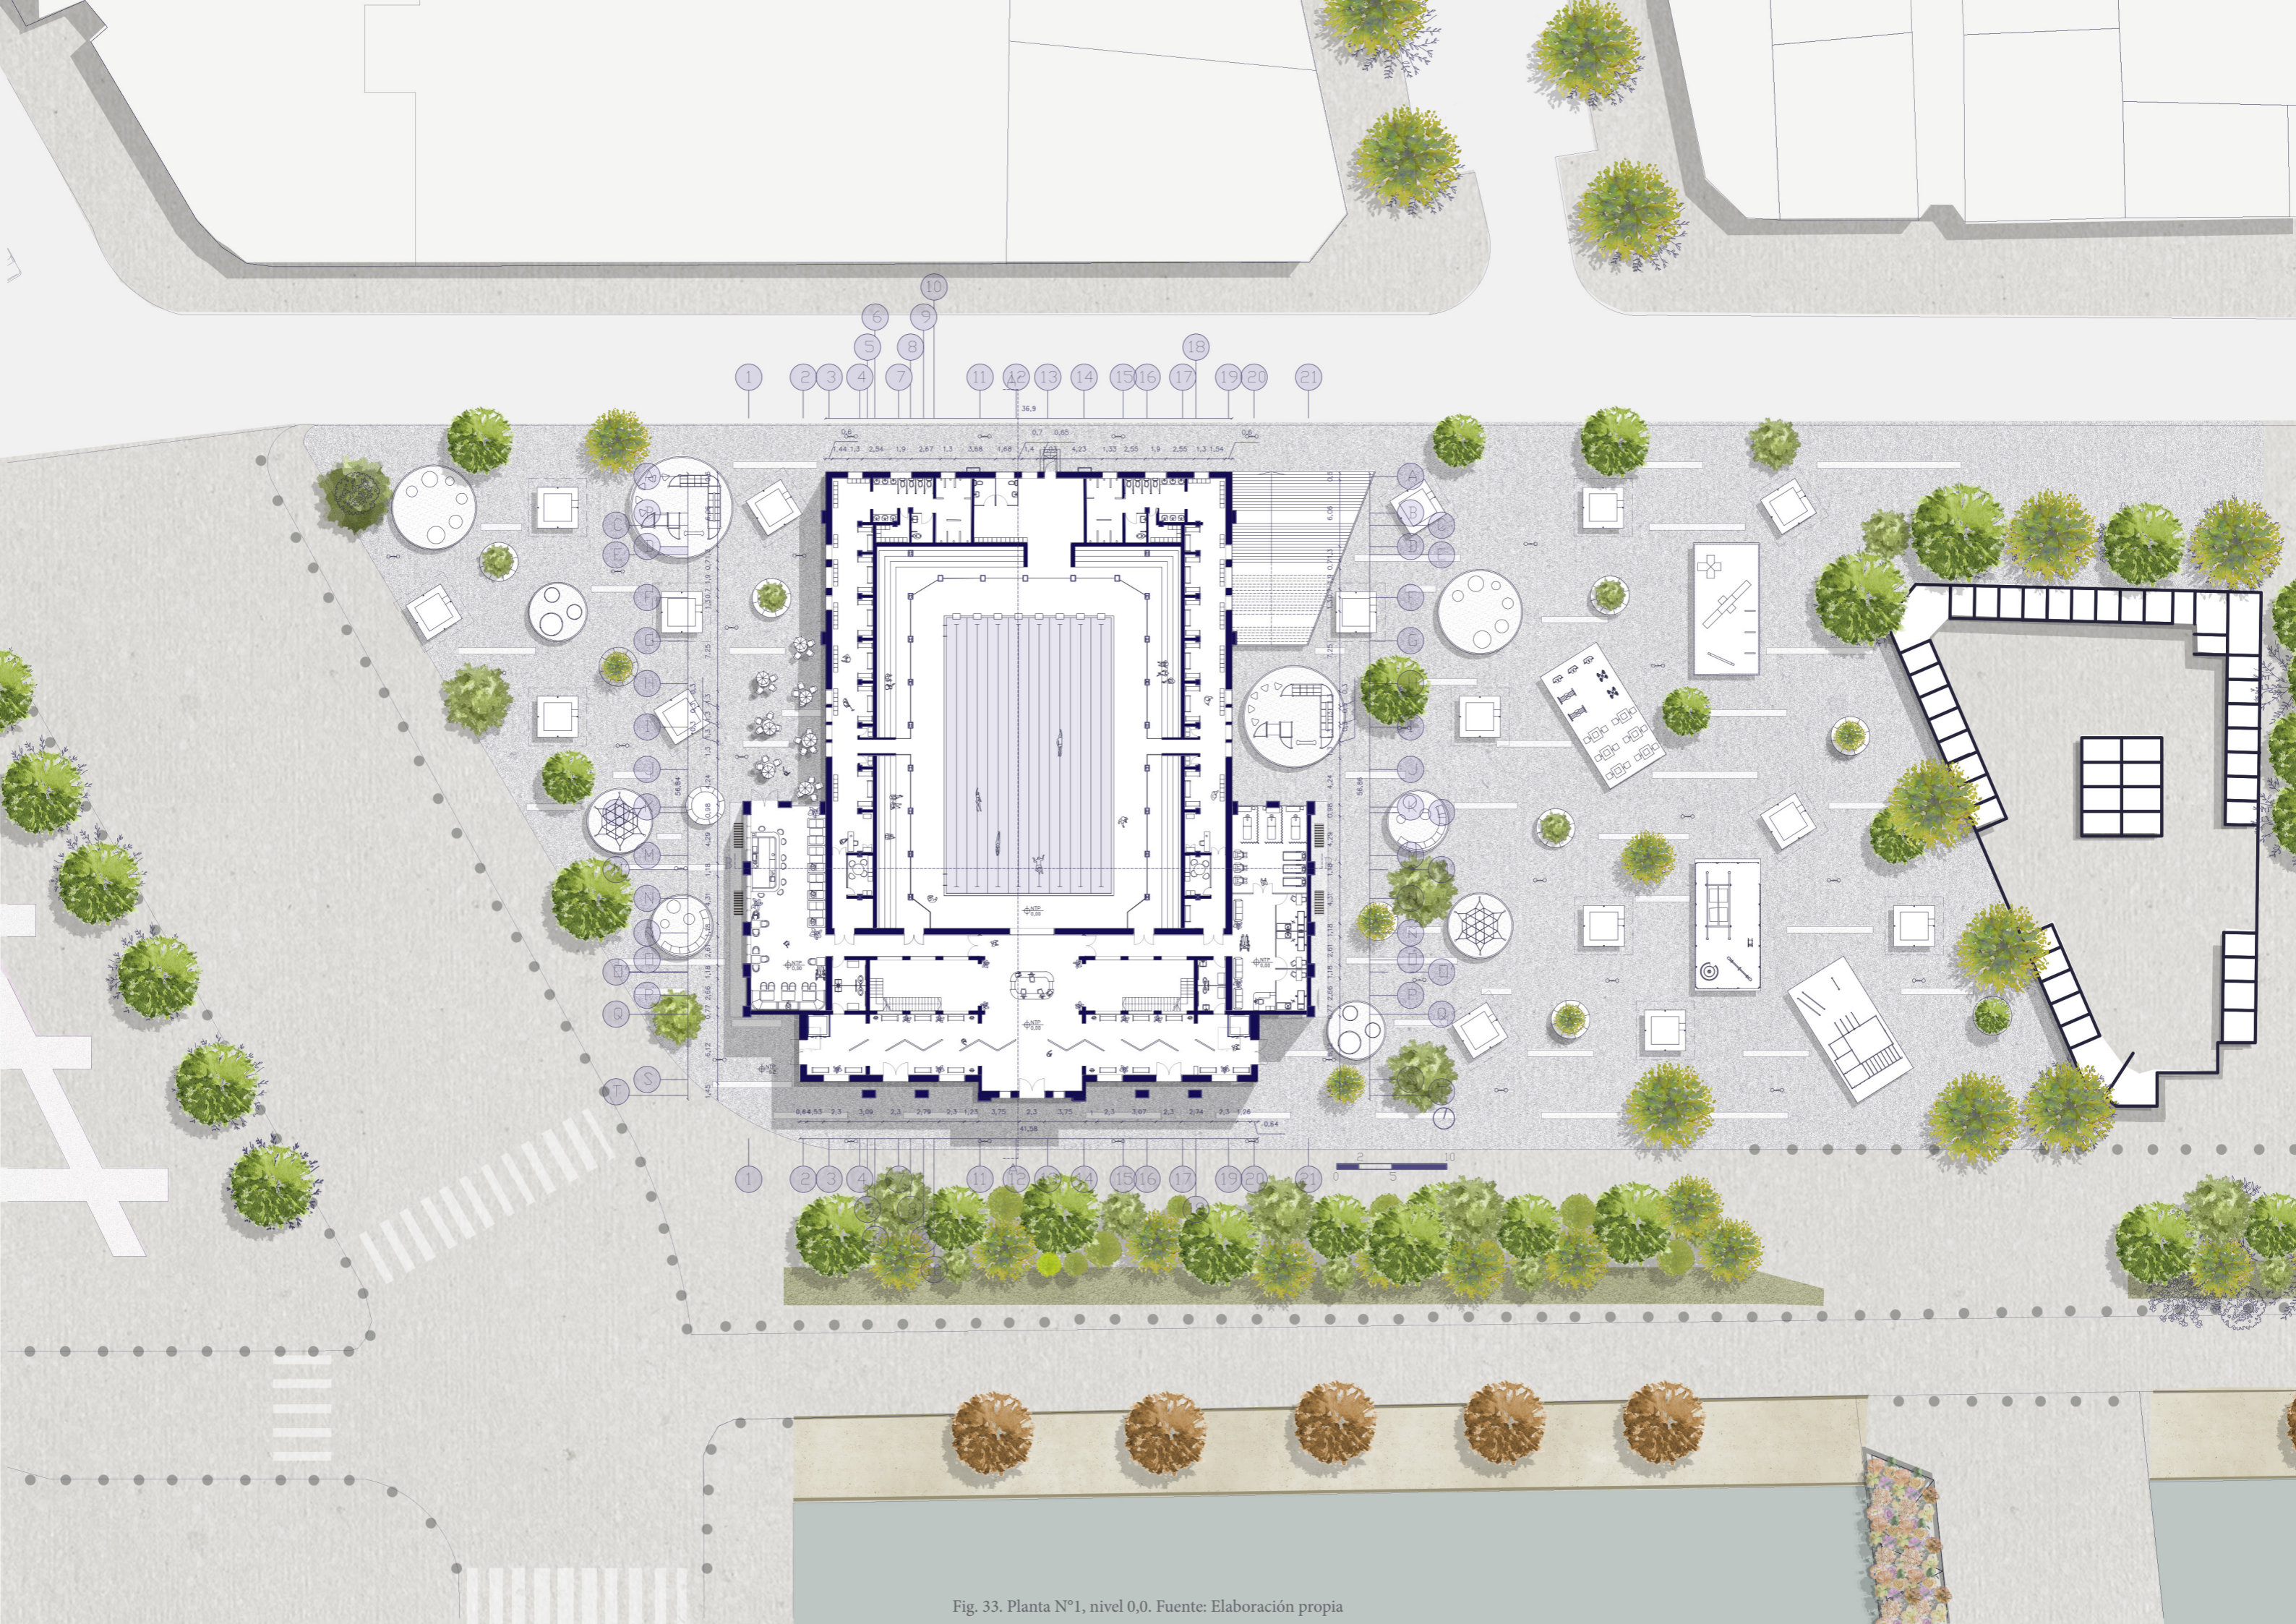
Planta N°1, nivel 0,0. Fuente: Elaboración propia
